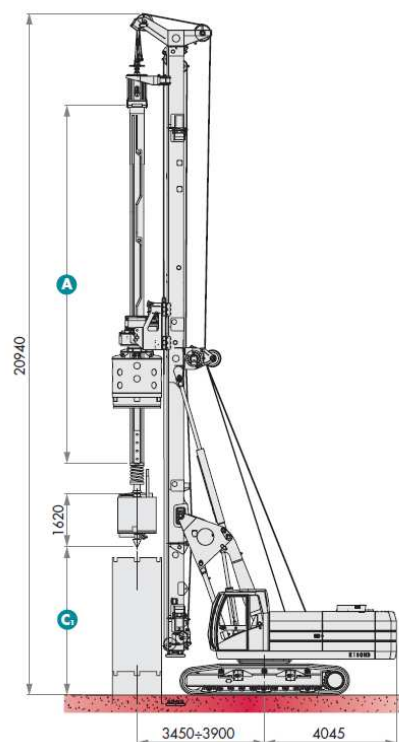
Přepravní rozměry vrtné soupravy CASAGRANDE B180
